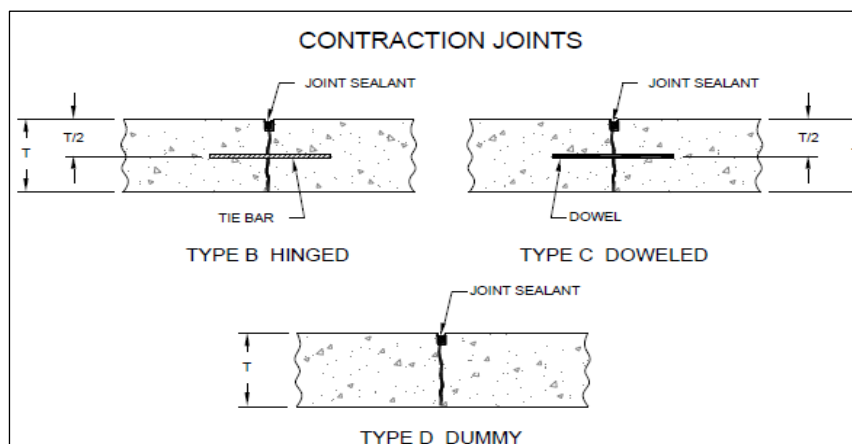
Esquema de las juntas de contracción de un pavimento de concreto hidráulico.
